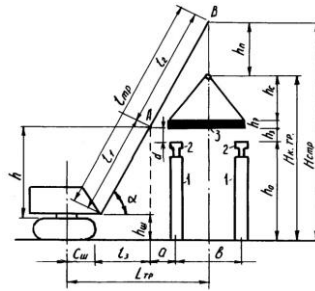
Схема для определения параметров стрелового крана аналитическим методом при монтаже плит покрытий
